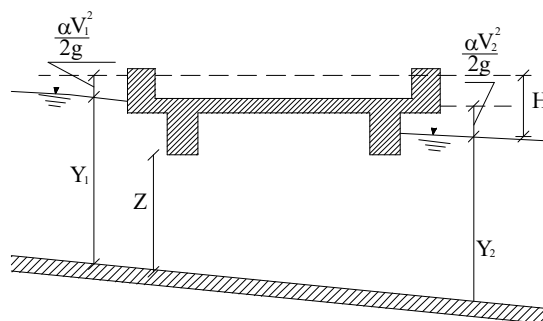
Sezione schematica di un ponte – Schema di calcolo
